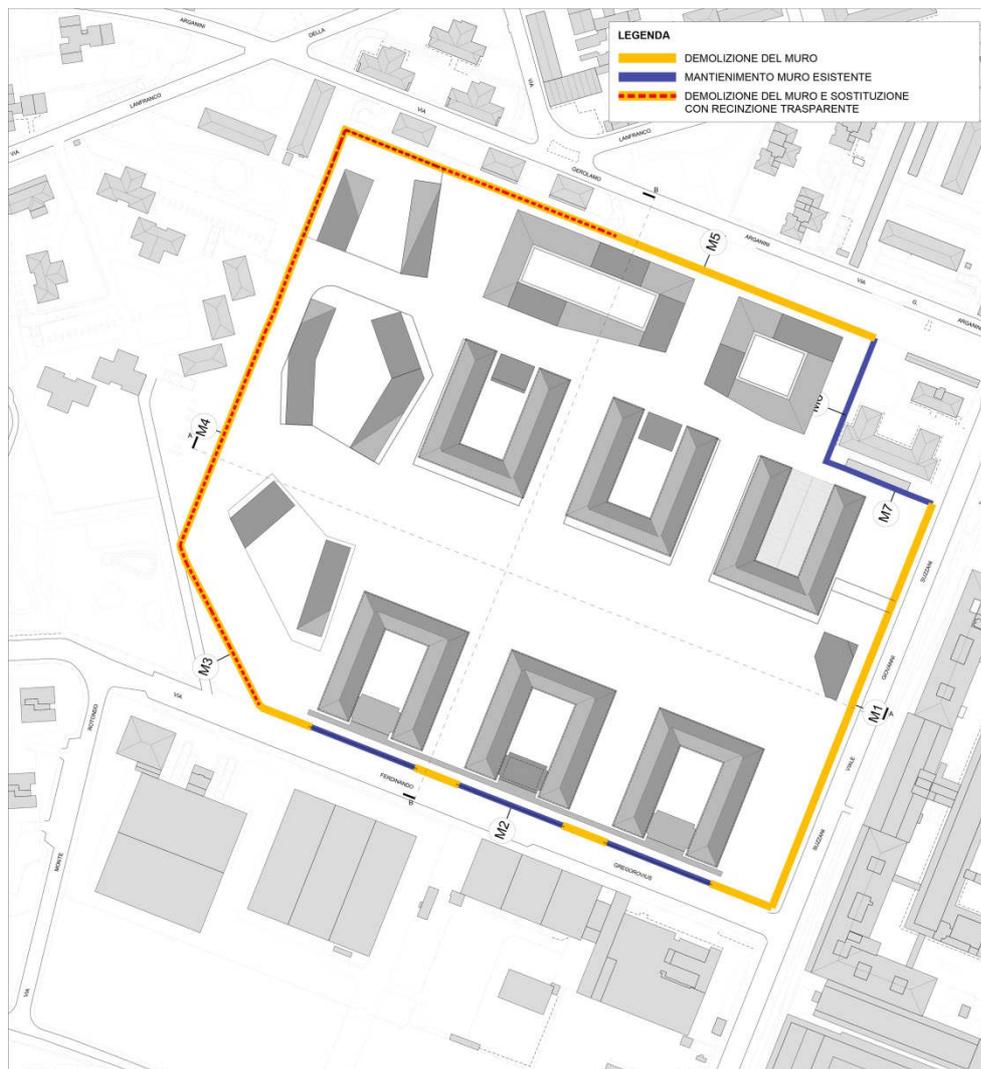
Progetto di intervento sulla muratura perimetrale
